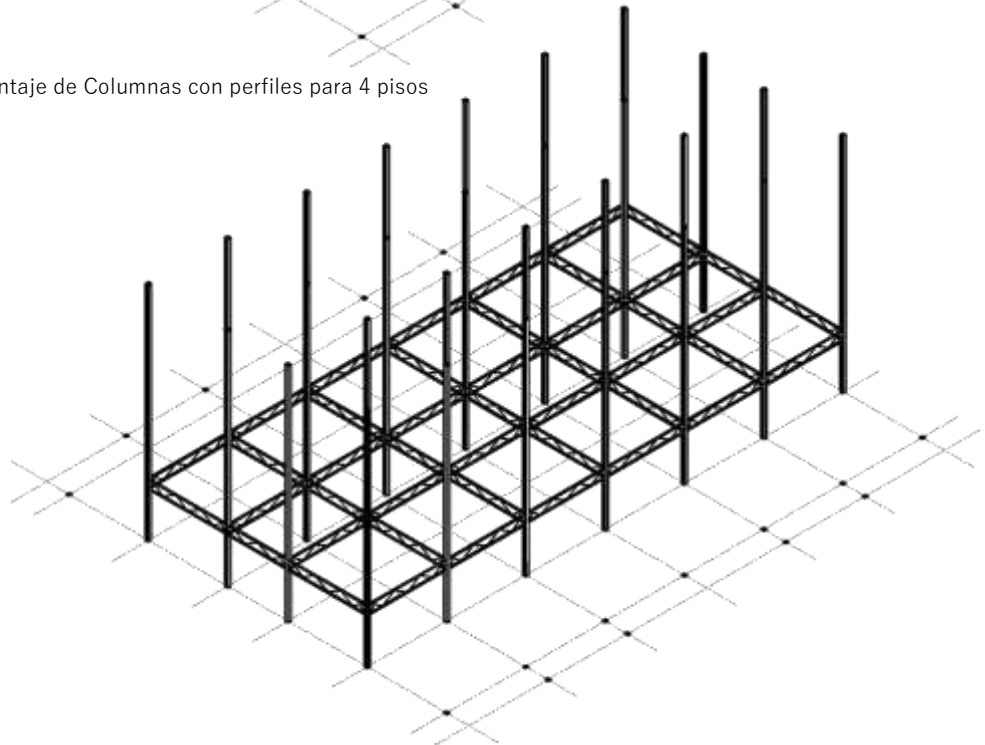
Montaje posterior de las vigas de celosías o cerchas (I Etapa)
